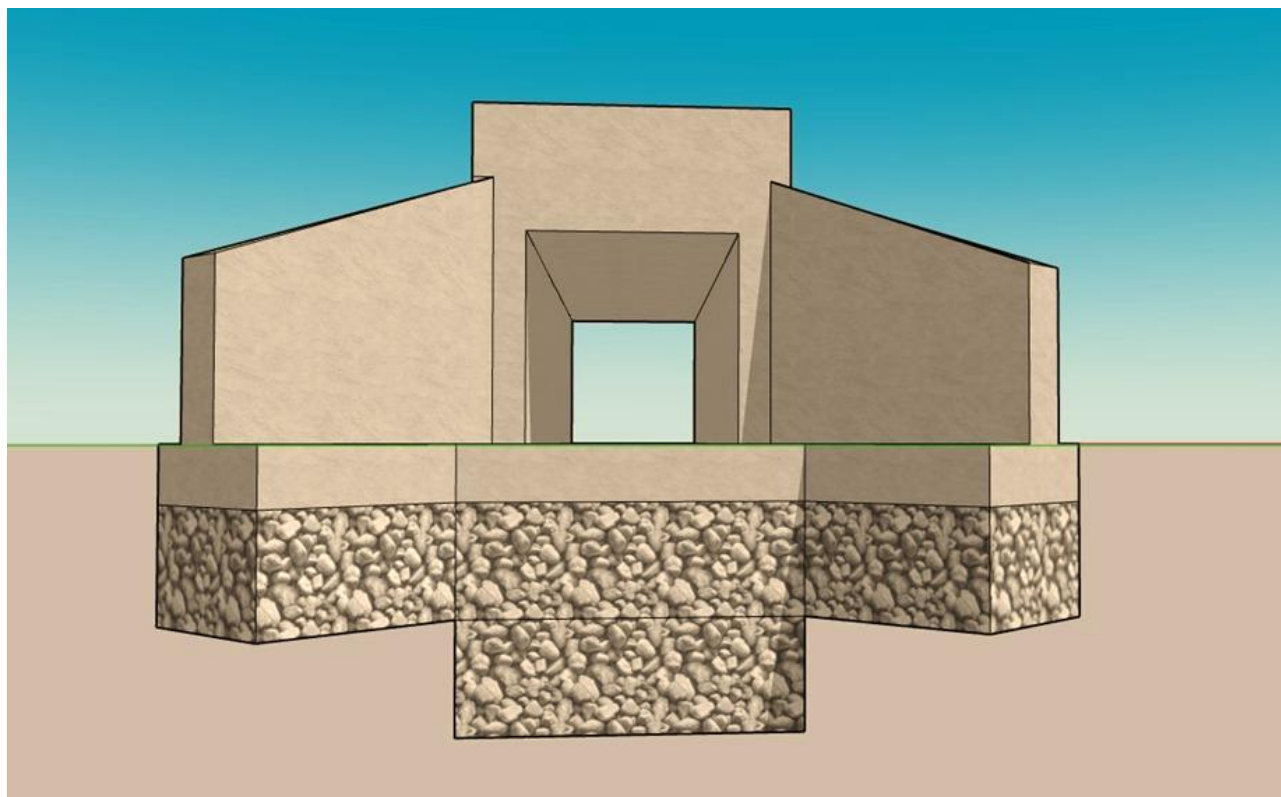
Esquema Mejoramiento Subsuelo de Soporte Para Obras de Drenaje
